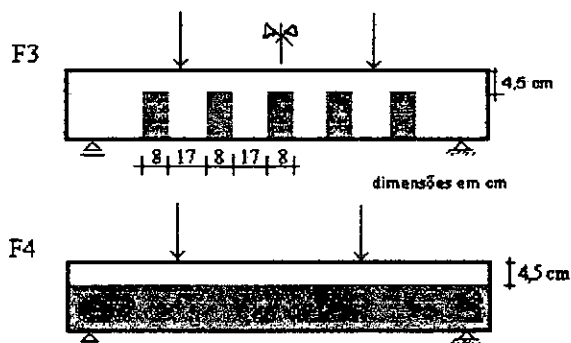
Detalhamento da armadura externa de reforço das vigas F3 e F4.
